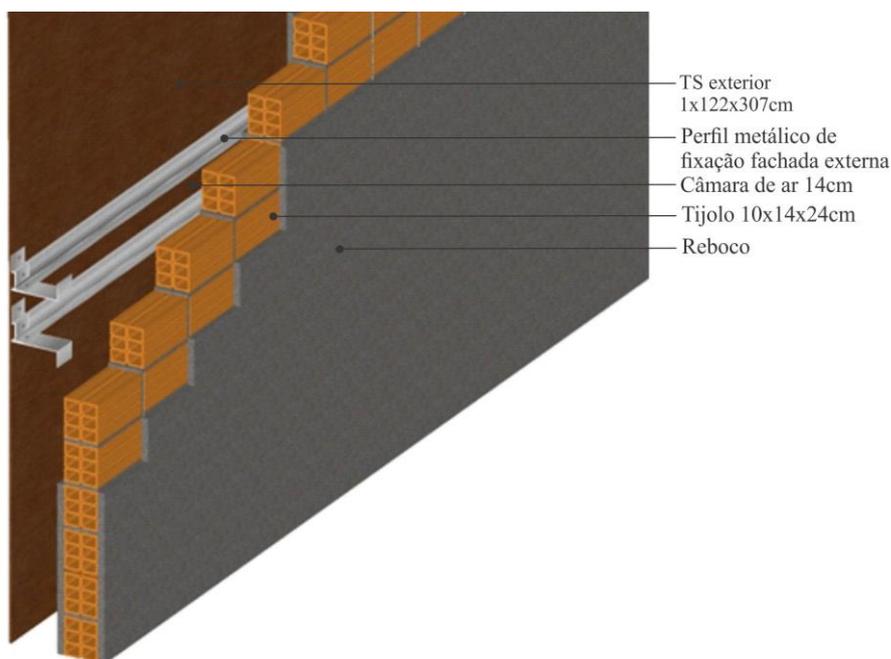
Estrutura da fachada ventilada. Fonte: Elaborado pela autora.
